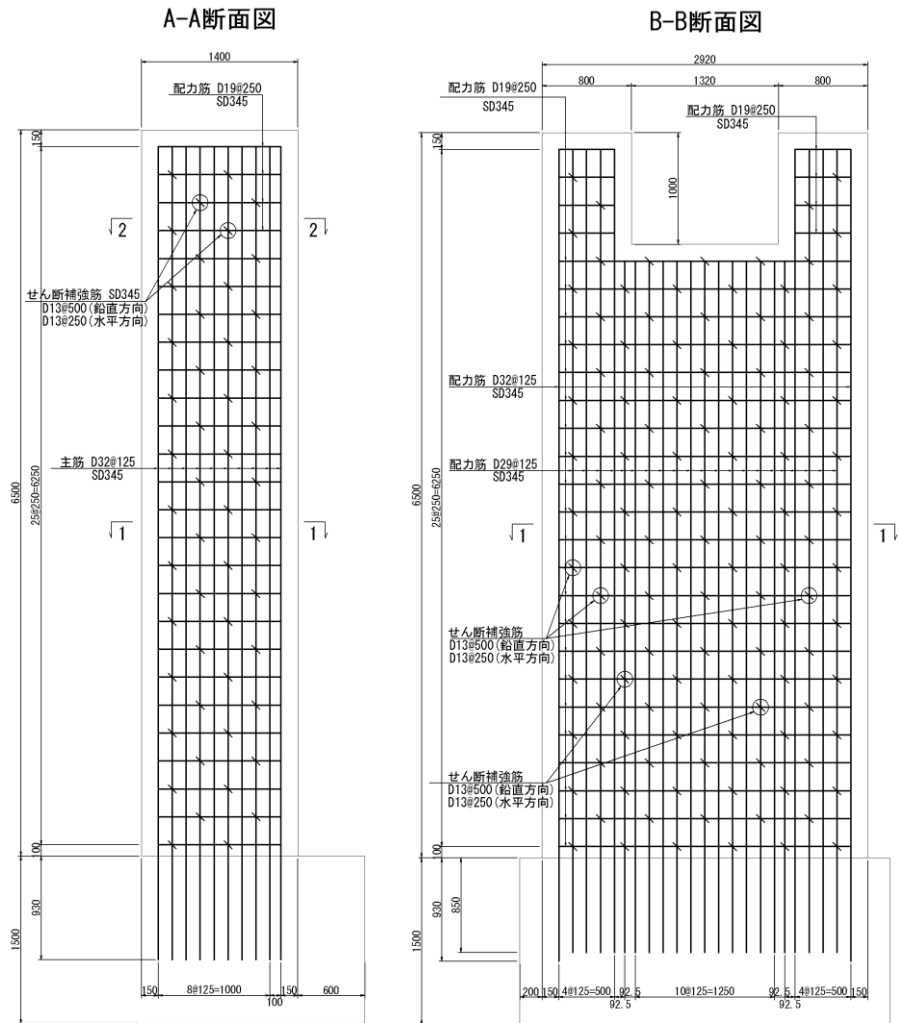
(2) 防波扉 (荷揚場南) の受枠 (RC 支柱) の配筋図 (A-A 断面, B-B 断面)
